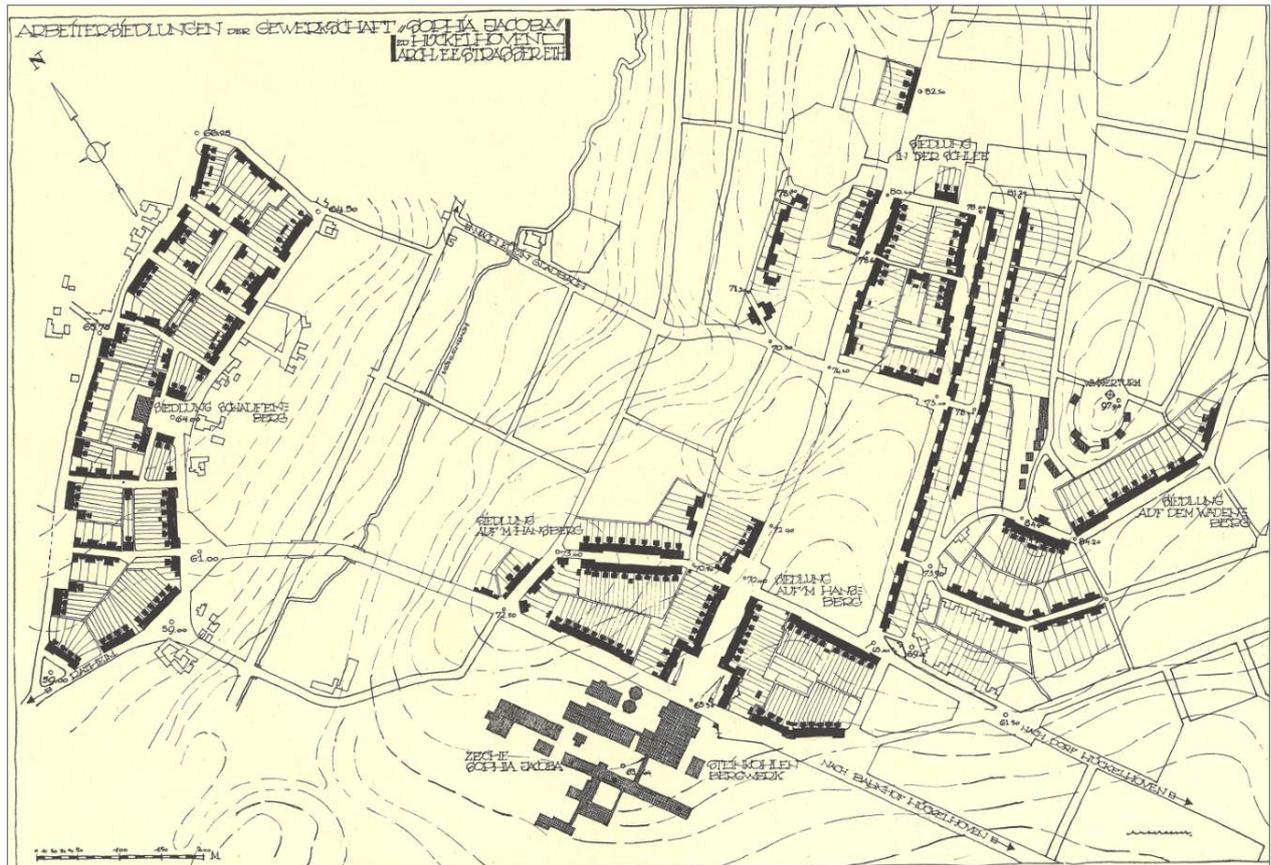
Ursprünglicher Siedlungsgrundriss nach Strasser
